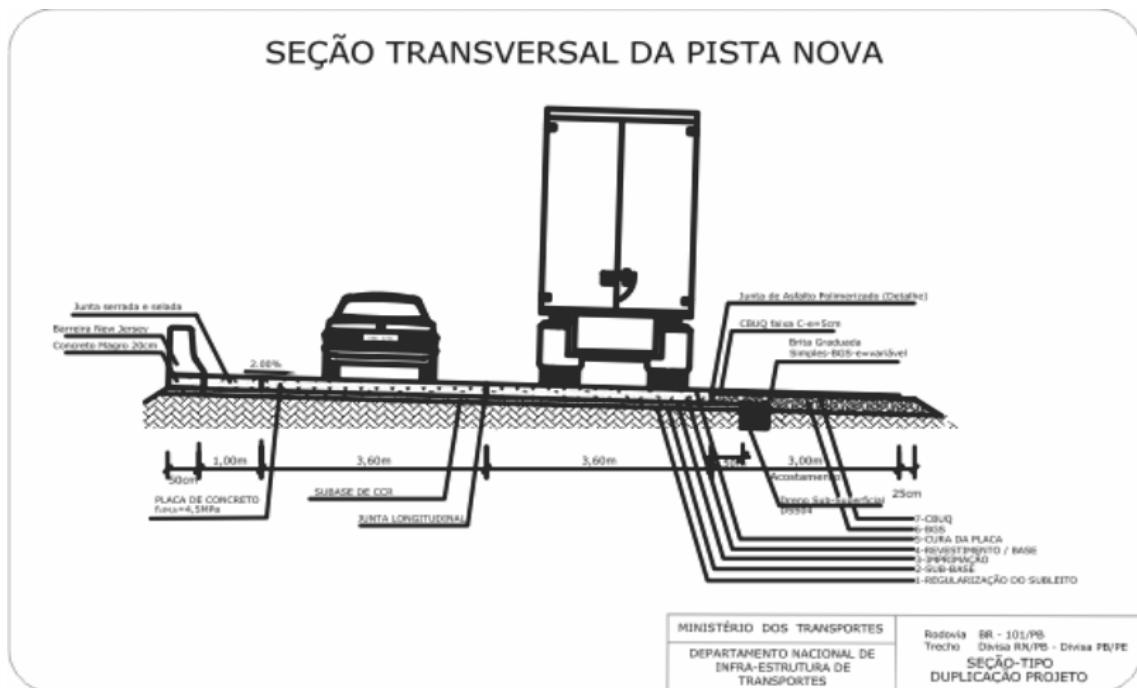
Seção Tipo da Duplicação BR-101 Nordeste
